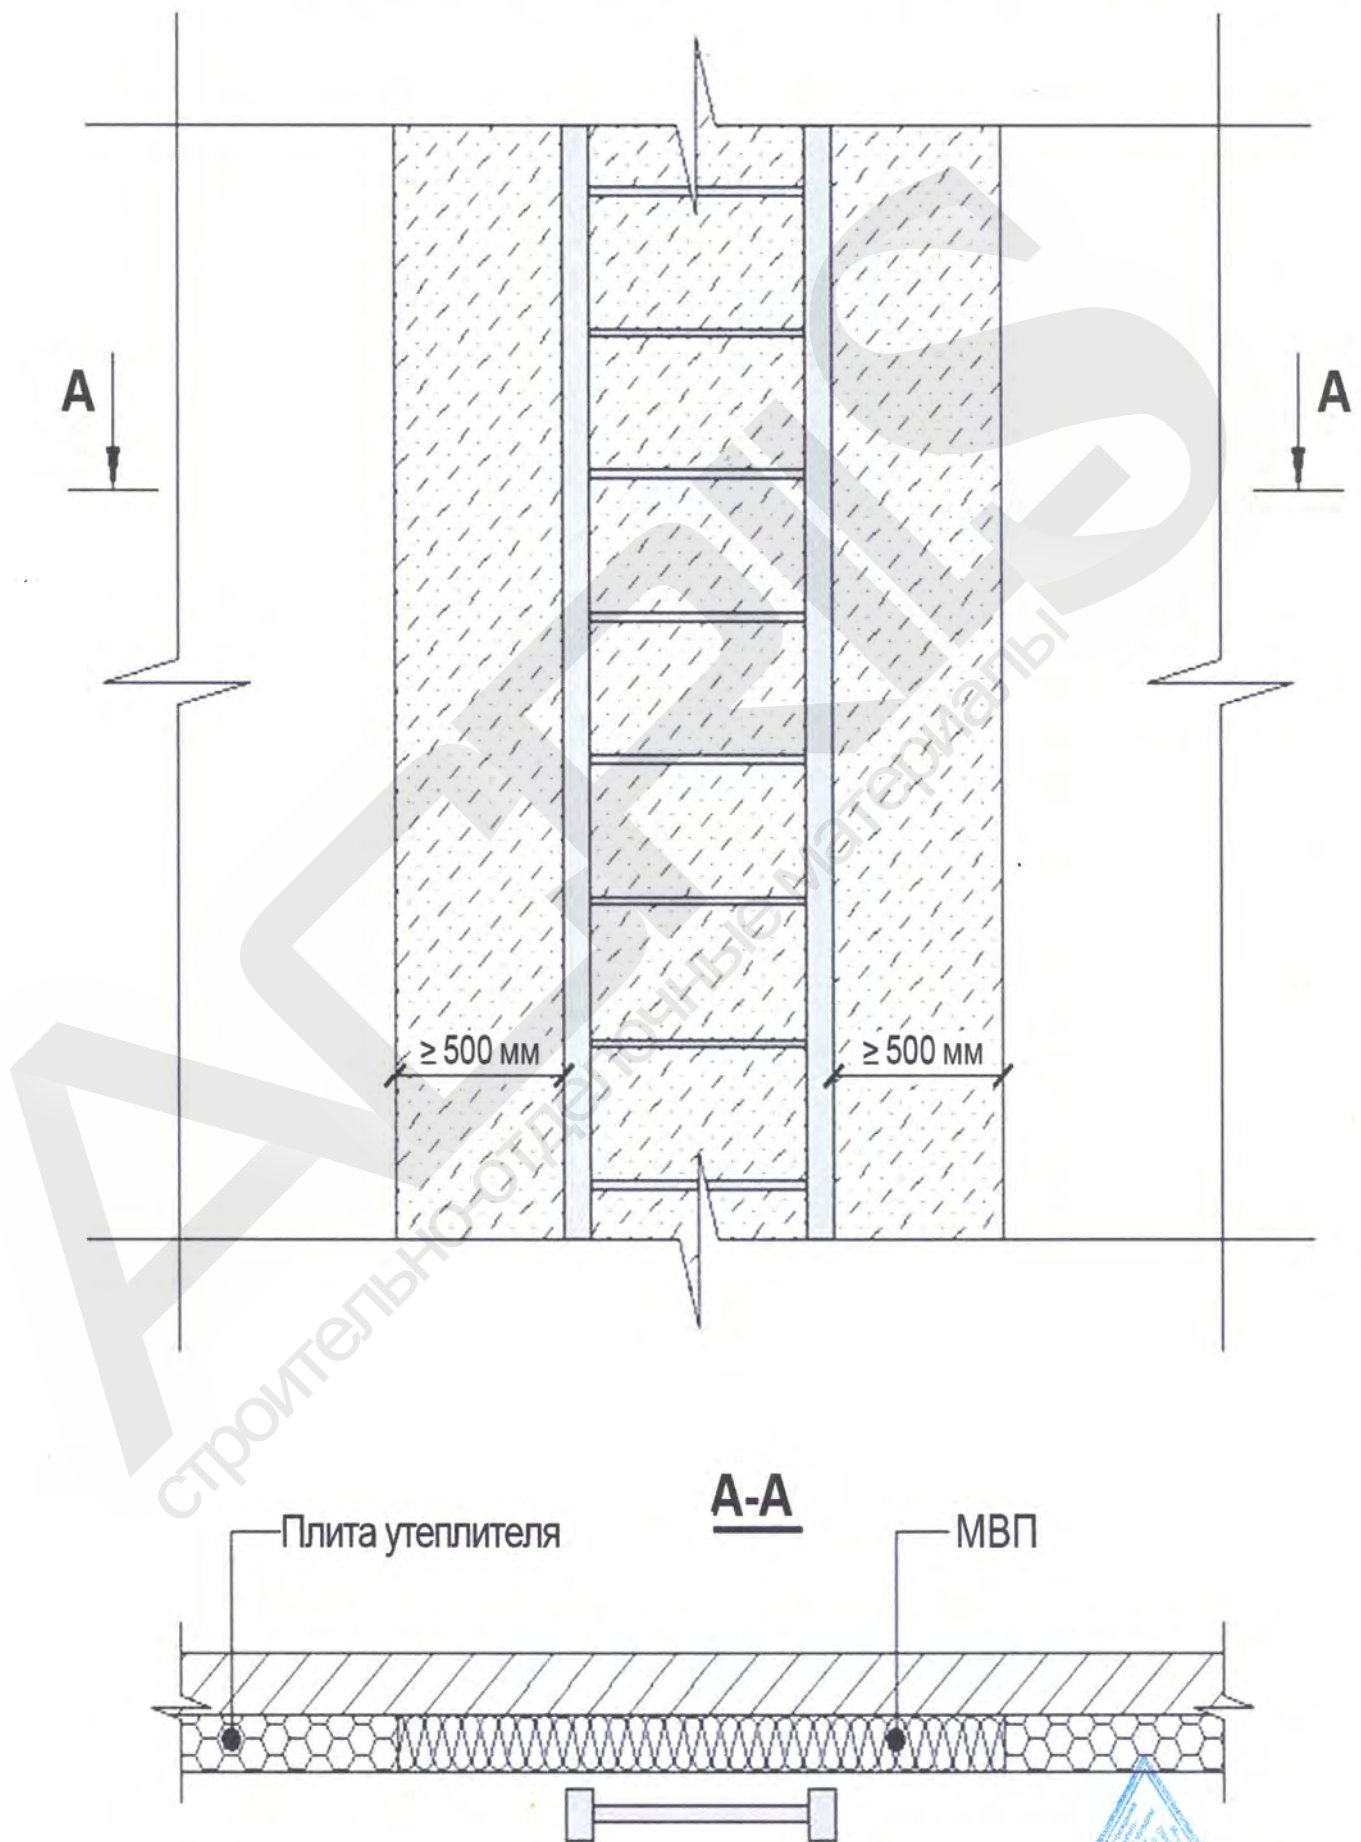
Участки примыкания СФТК к пожарной или наружной маршевой лестнице здания
